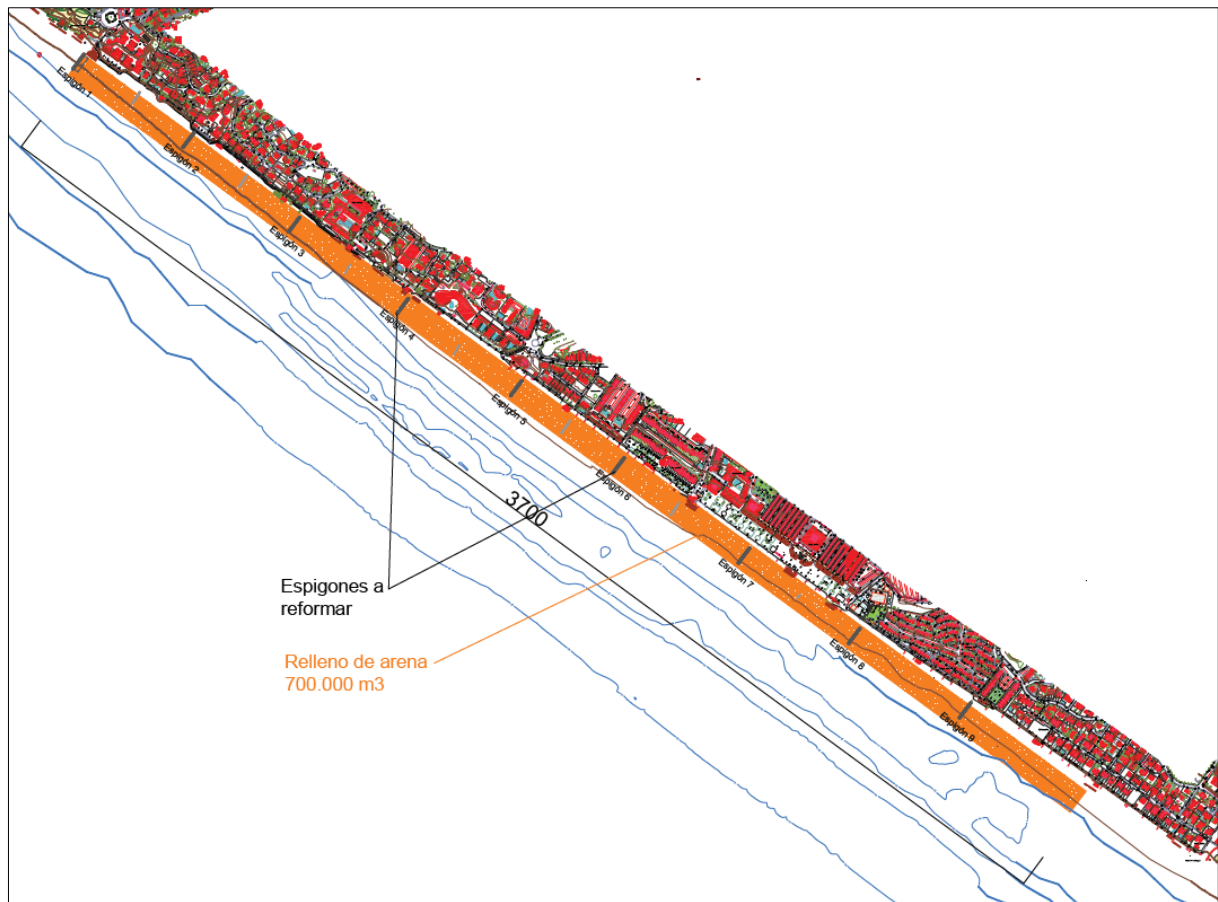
Planta general de la alternativa propuesta (Alternativa 6)
